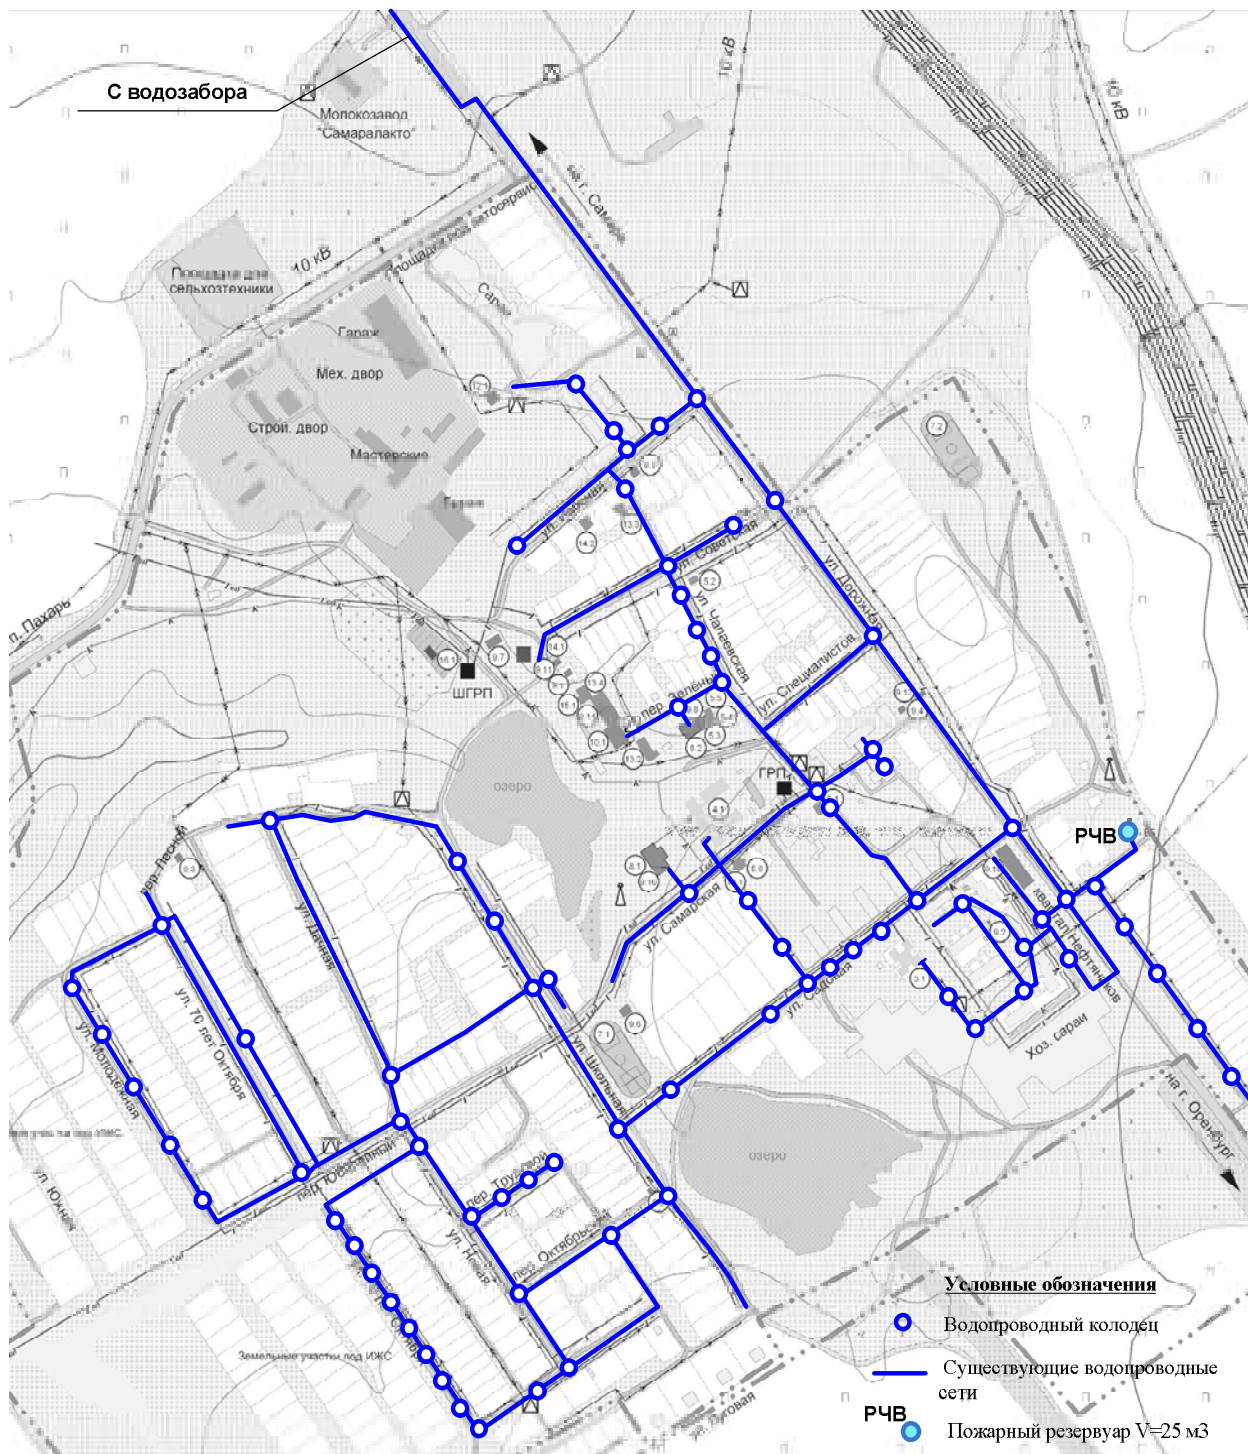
План водопроводных сетей п. Просвет
